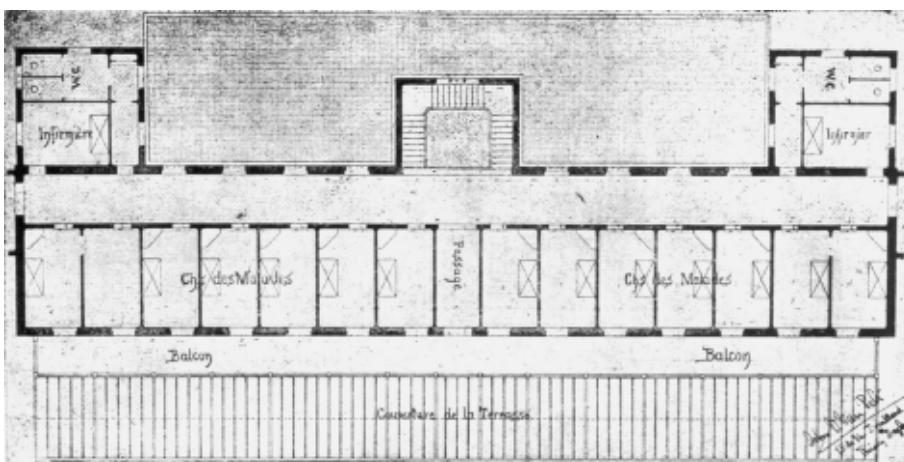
Grundriss der ersten Etage eines Pavillons nach Knopf und van Pelt (Knopf, 1900).
